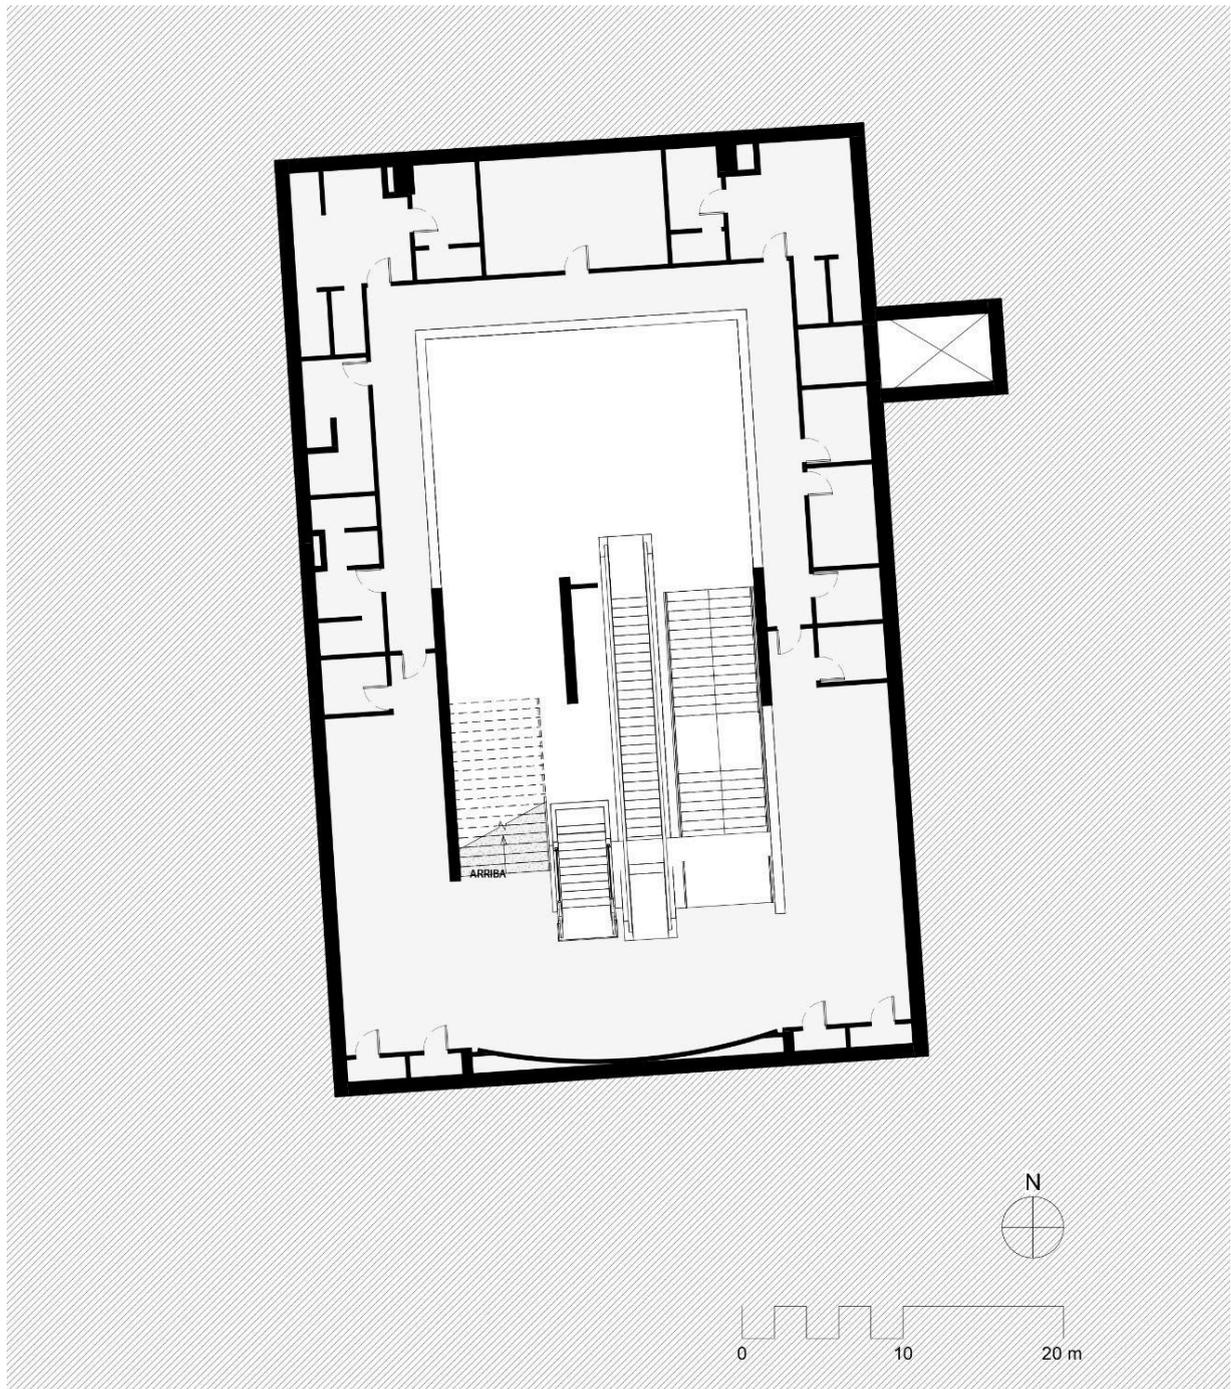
Planta nivel -2. Fuente: Elaboración propia.
